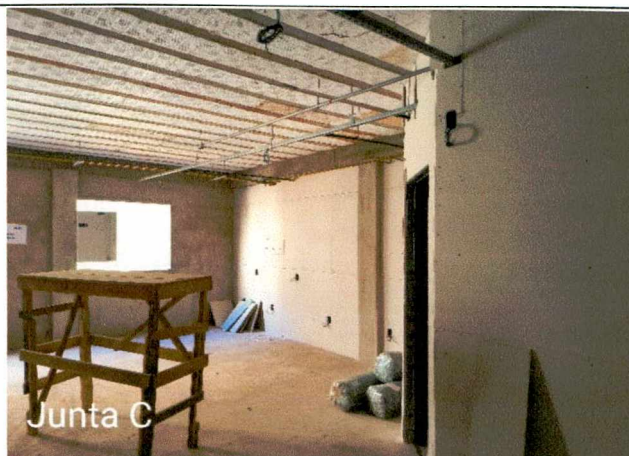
a 7: Execução de impermeabilização das calhas; montagem da estrutura metálica; execução de instalações elétricas;
